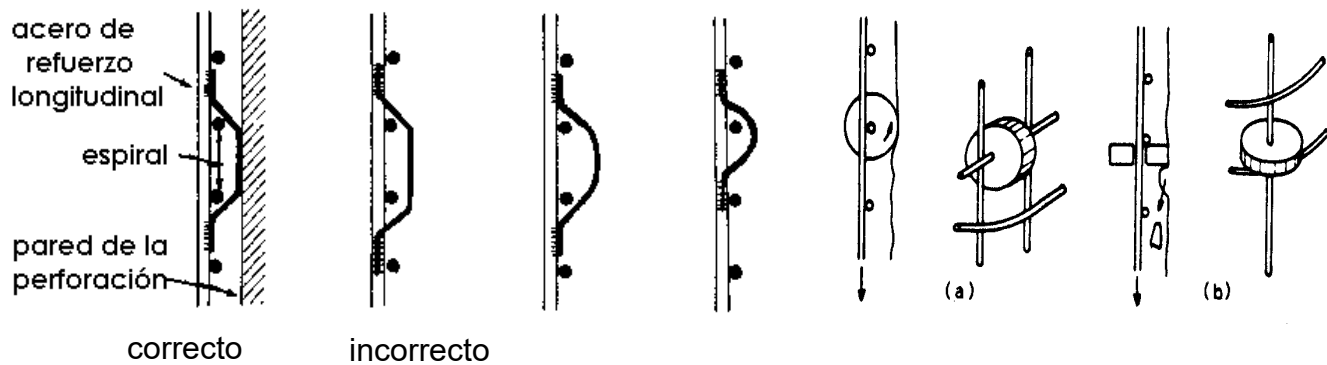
, ELEMENTOS PARA RECUBRIMIENTO EN PILAS (LCPC, 1986)
